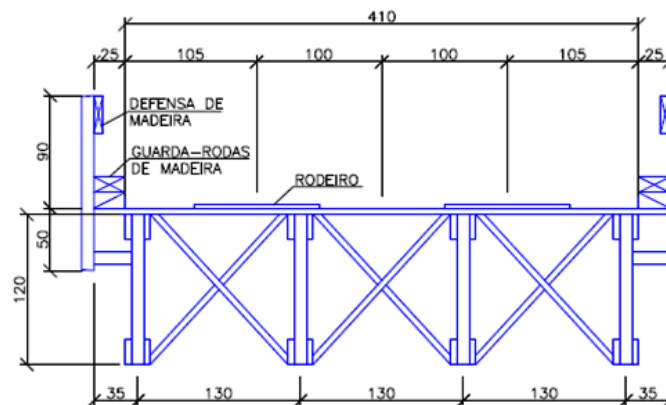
Exemplo de estrutura de ponte em madeira com sistema treliçado
